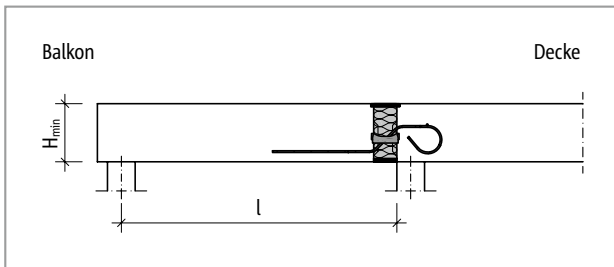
Schöck Isokorb® T Typ Q: Statisches System (T Typ Q-V1 bis Q-V5)
